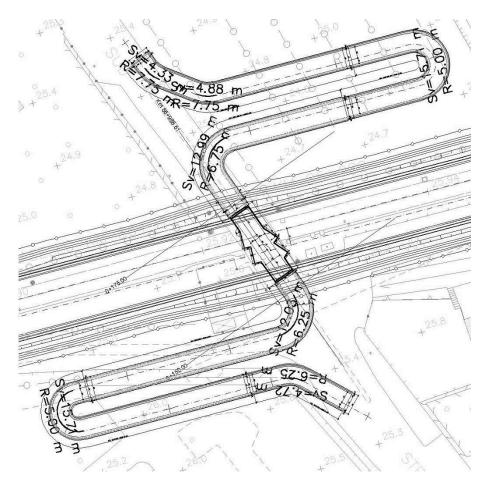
inquadramento planimetrico pista ciclo-pedonale
